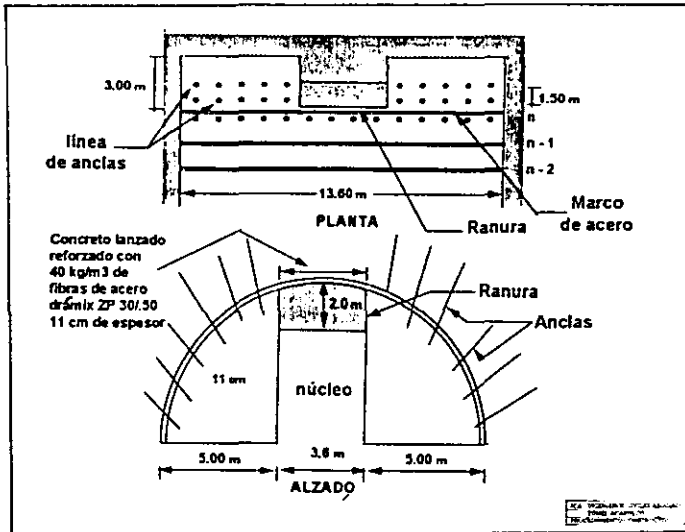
Excavación de la porción superior del tercio central y colocación de concreto lanzado en la clave.
